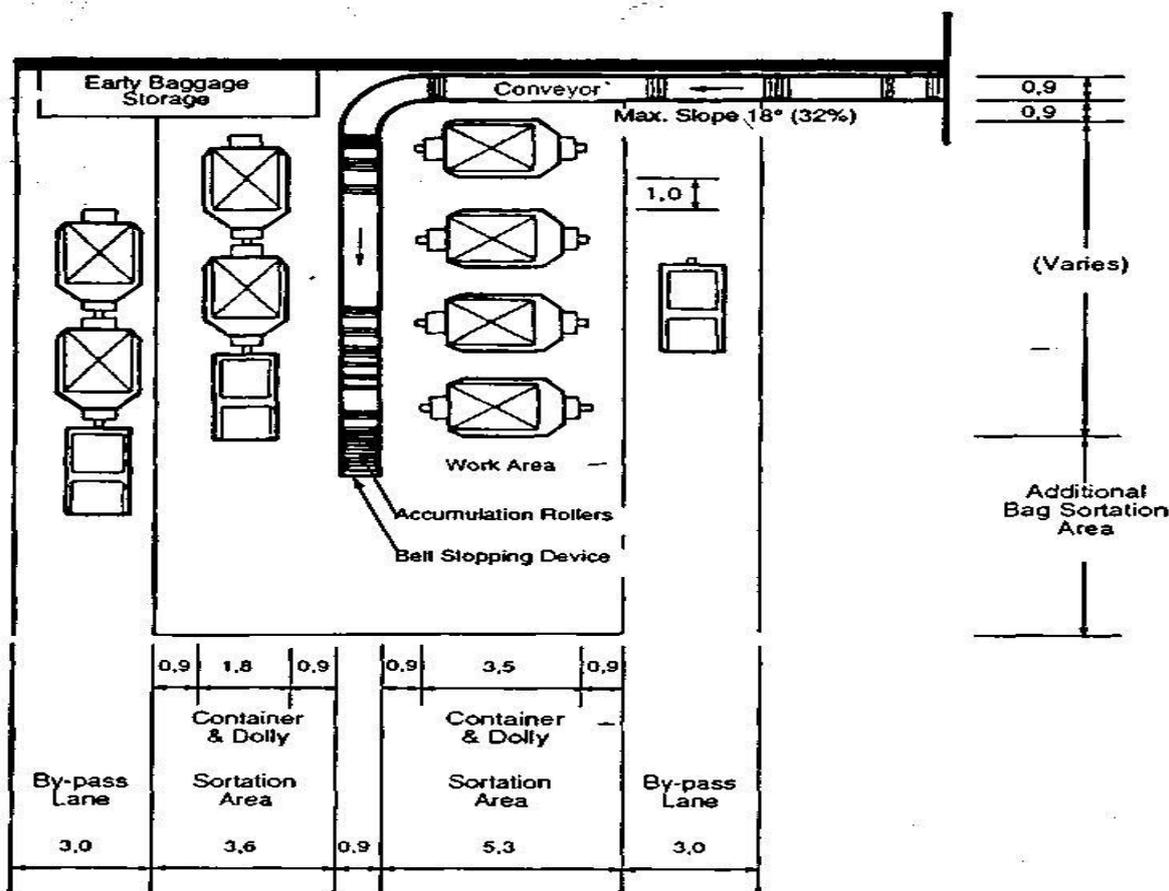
Система сортировки убывающего багажа с одним питателем (Dimensions in meters)
